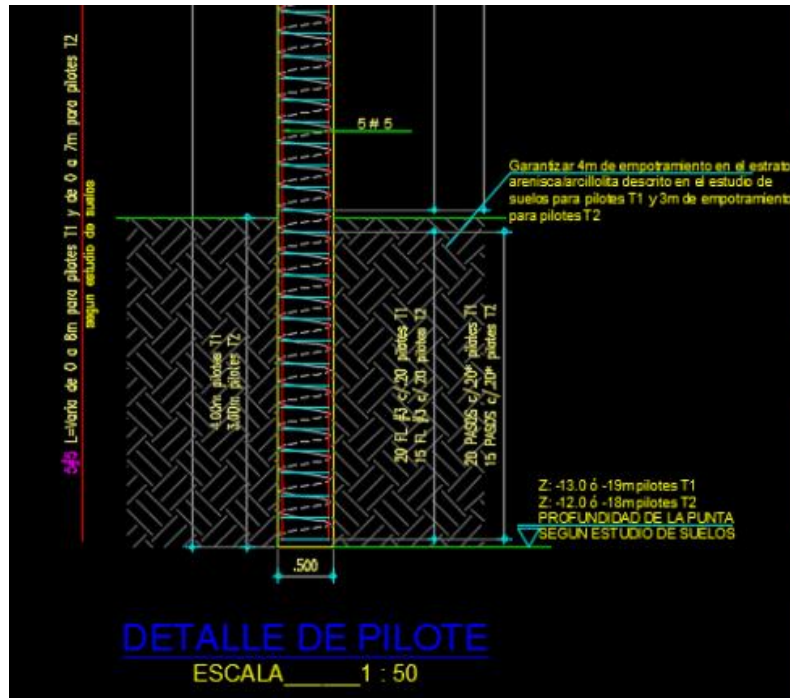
Detalle de pilotes, fuente Ingeniero Néstor Roncancio.
